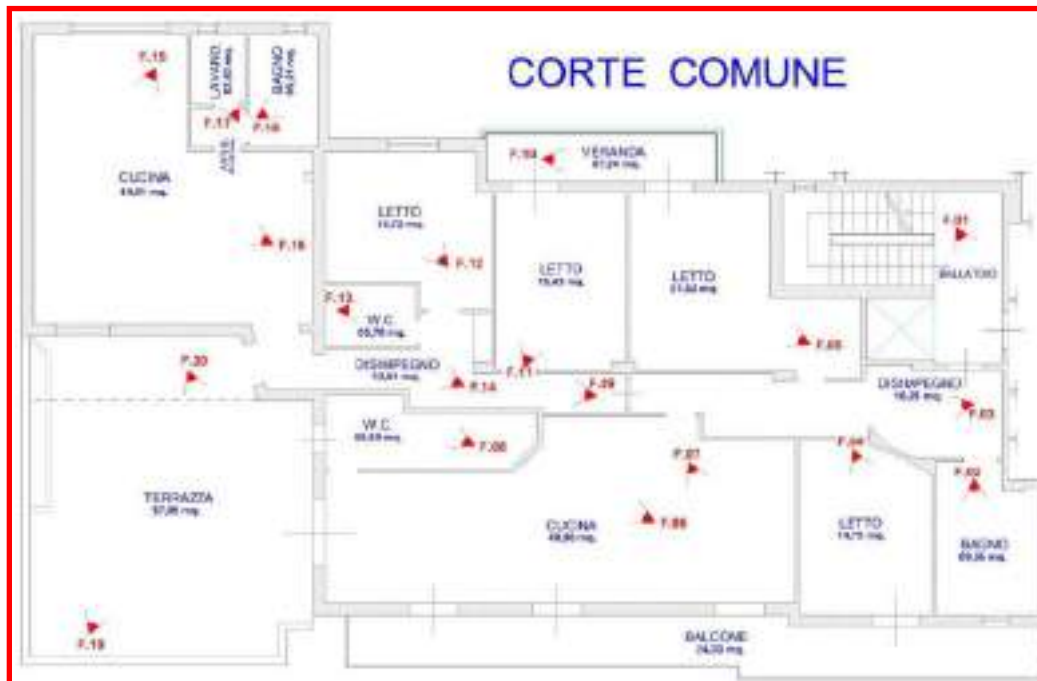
Confronto planimetrie stato di fatto e planimetrie catastali
